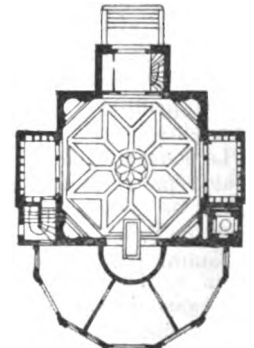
Plan du rez-de-chaussée du four crématoire de Hambourg.
